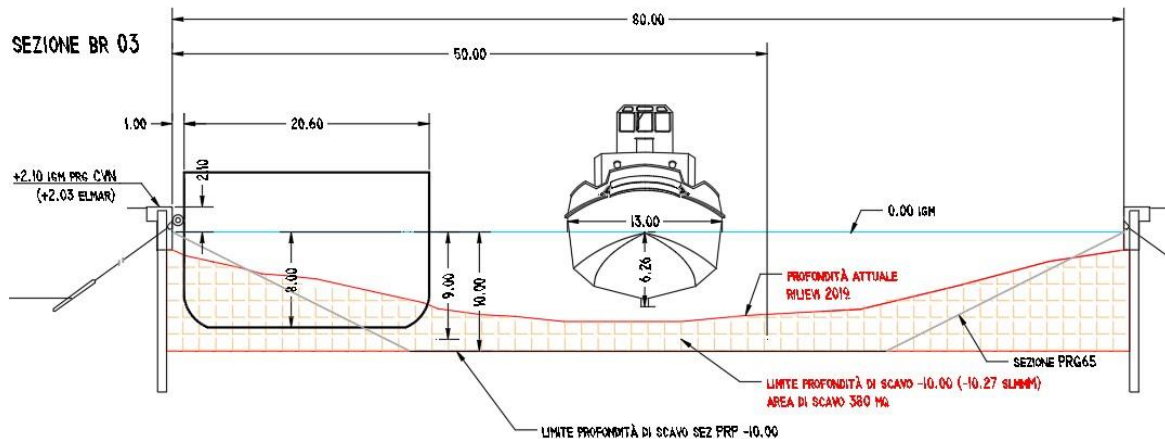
Sezioni tipologiche di dragaggio confronto tra lo stato di fatto e lo stato di progetto, Canale Brentella.
